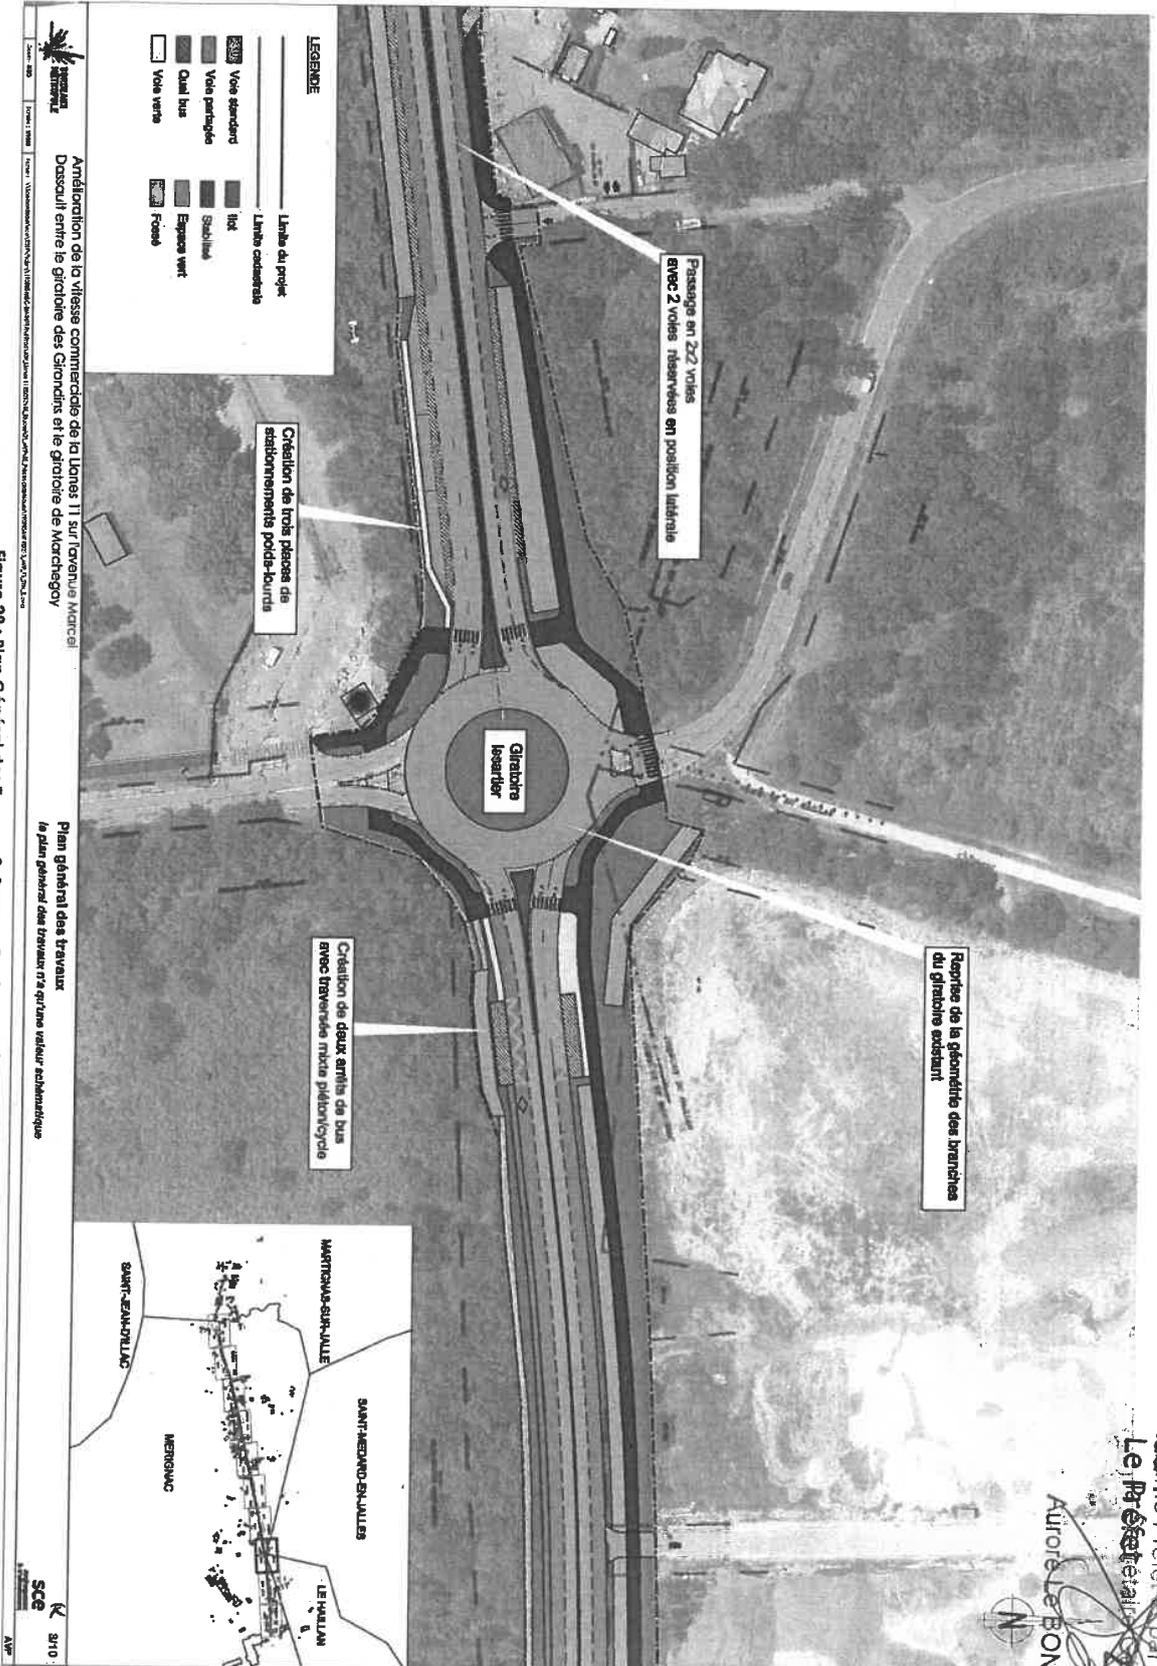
Plan Général des Travaux & Source : Bordeaux Métropole
